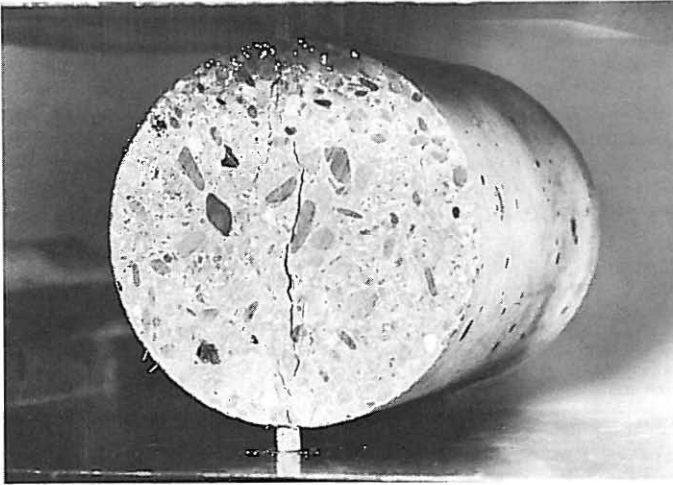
Spaltzugprüfung eines Stahlfaserbetons
